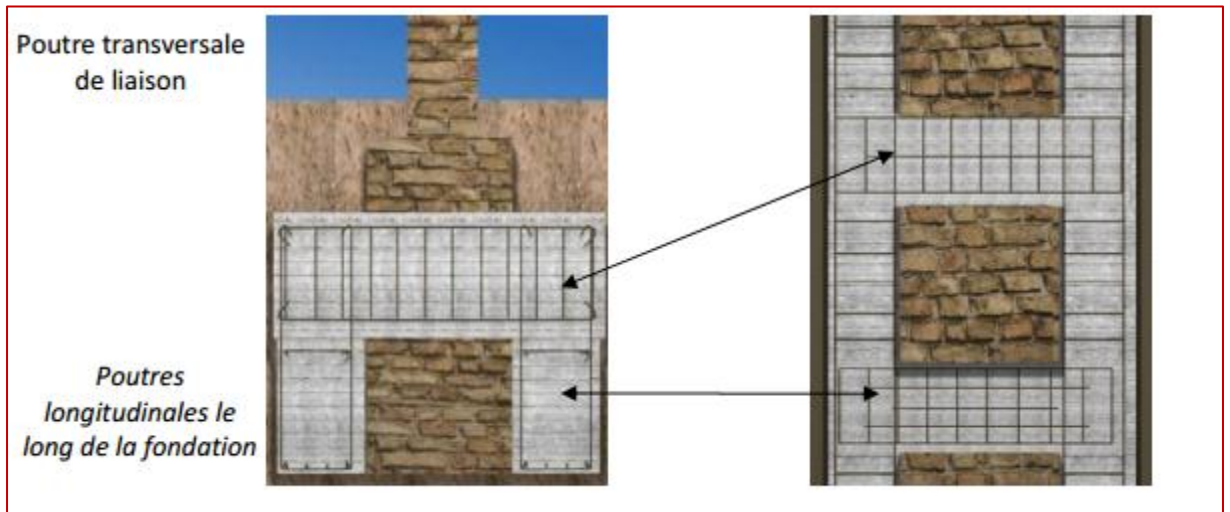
Renforcement des fondations par des poutres longitudinales rattachées par les poutres transversales.
